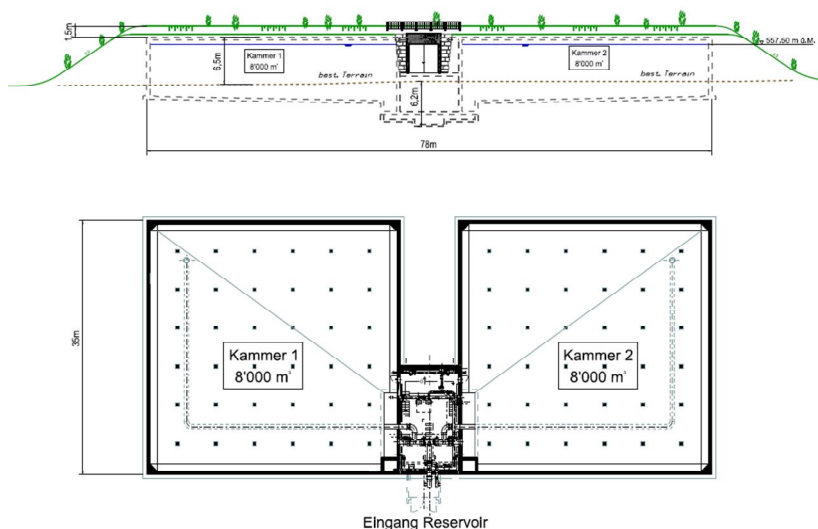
Schnitt und Grundriss des neuen Reservoirs.
